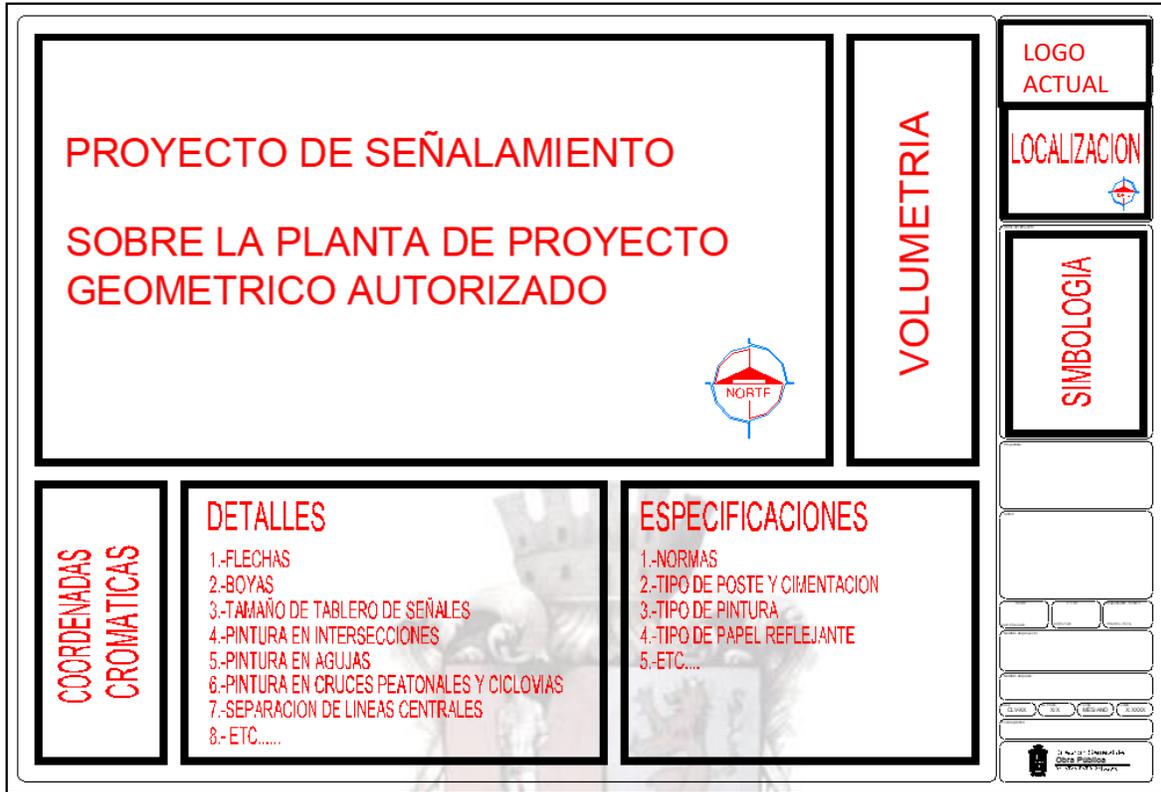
Plano llave para proyecto de señalamiento vial.
